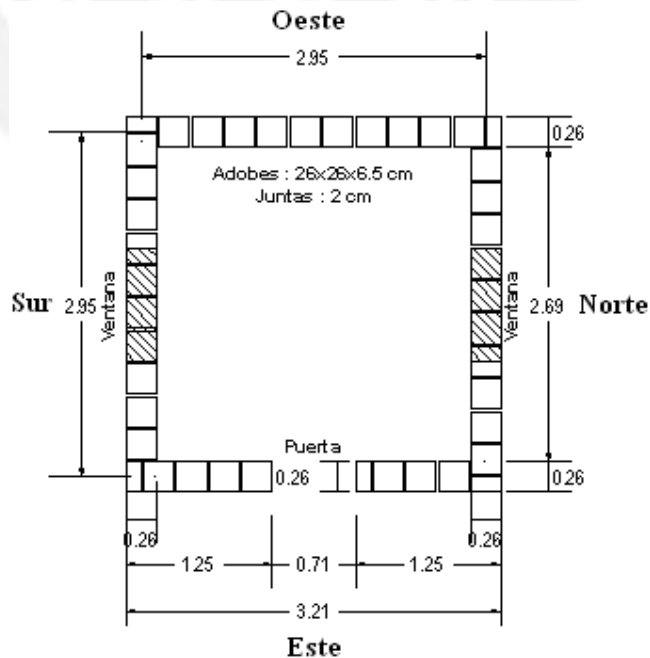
Vista en Planta y distribución o emplantillado de los bloques de adobe
